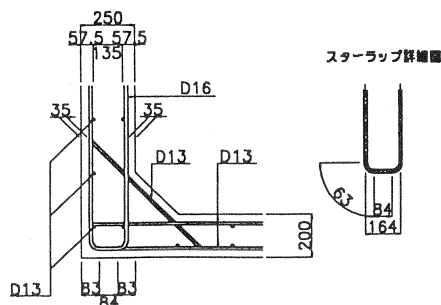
鉄筋の曲げ加工を考慮した最小ウェブ厚
